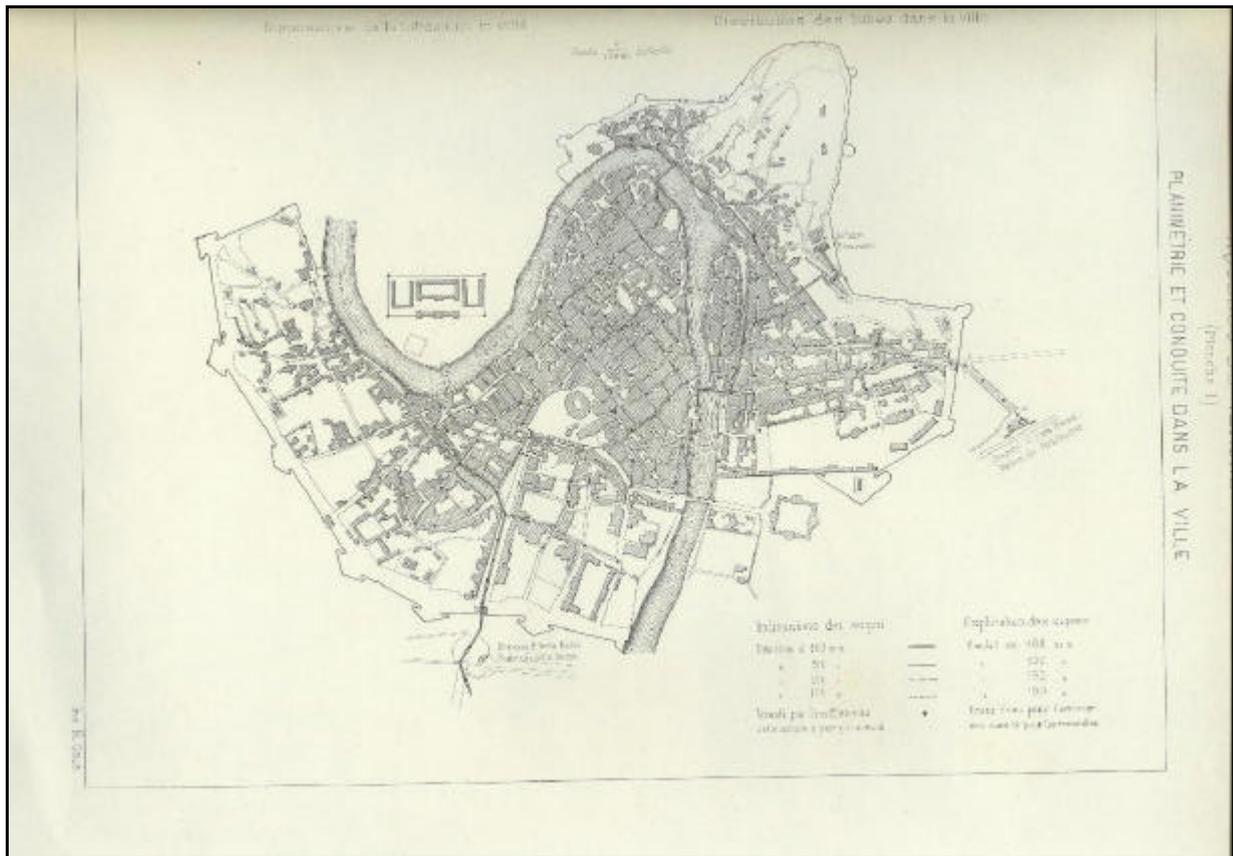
Planimetria della città di Verona e il tracciato delle condutture dell’acquedotto (Carli, 1893)
